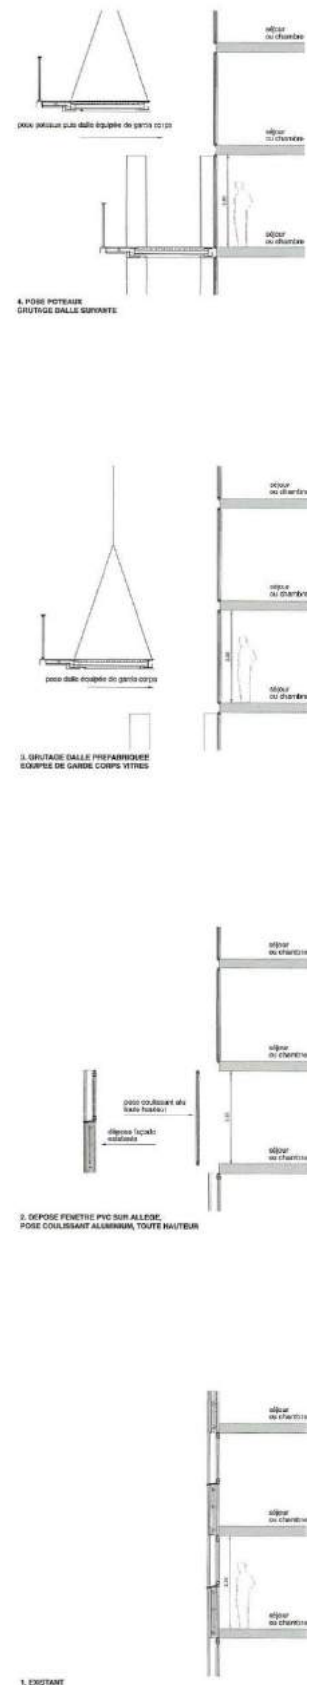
Processo de instalação dos módulos pré-fabricados na fachada exterior
